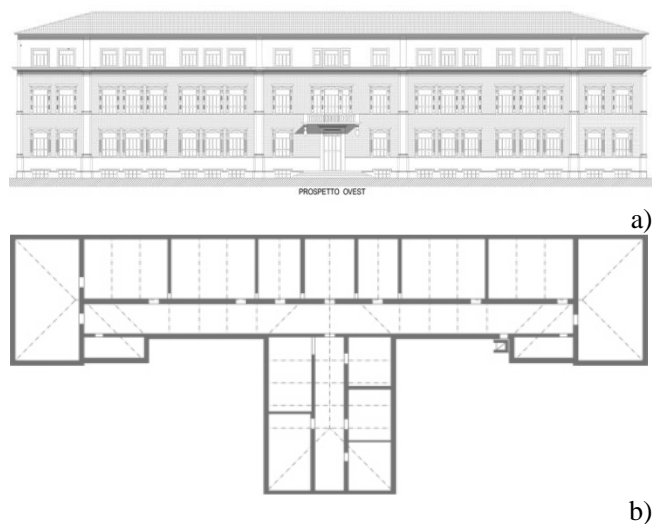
a) Prospetto principale dell'ex Tribunale di Fabriano, oggetto di modellazione; b) Pianta dell'edificio
